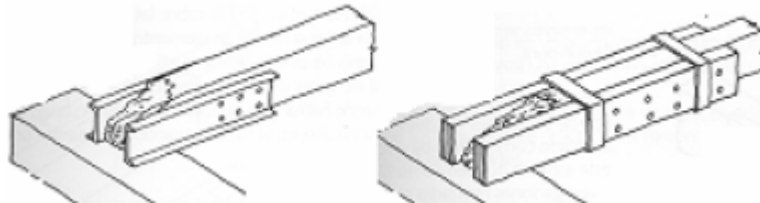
Reforço com perfis metálicos ou peças de madeira unidas por braçadeiras metálicas (Arriaga, 2002)
